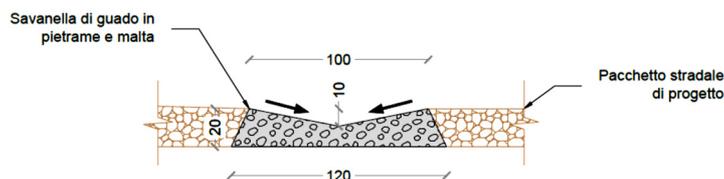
Sezione "Tipo" canaletta di drenaggio realizzata in scavo
